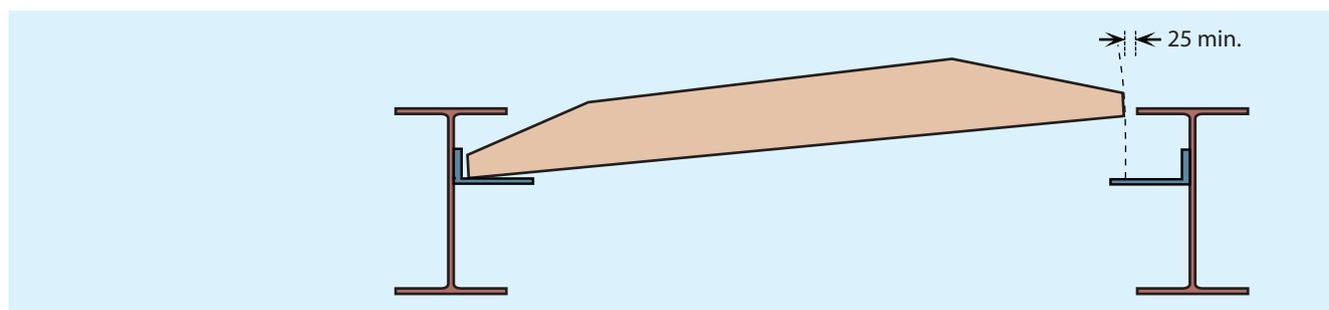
Опирание сборных плит на стальные балки с опорными уголками и требуемые зазоры
